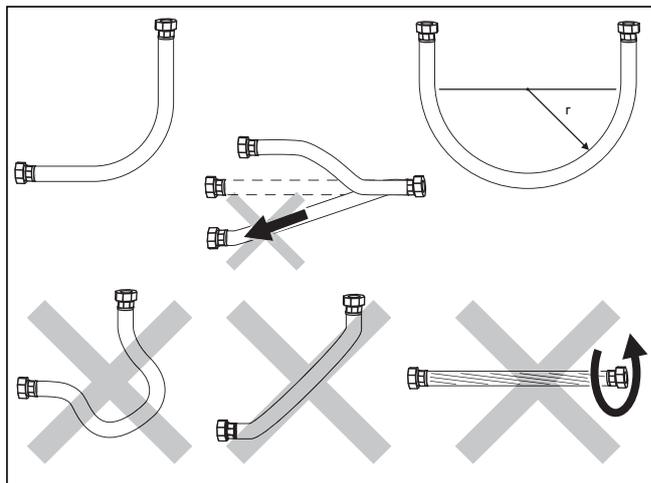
Umgang mit flexiblen Anschlussleitungen
